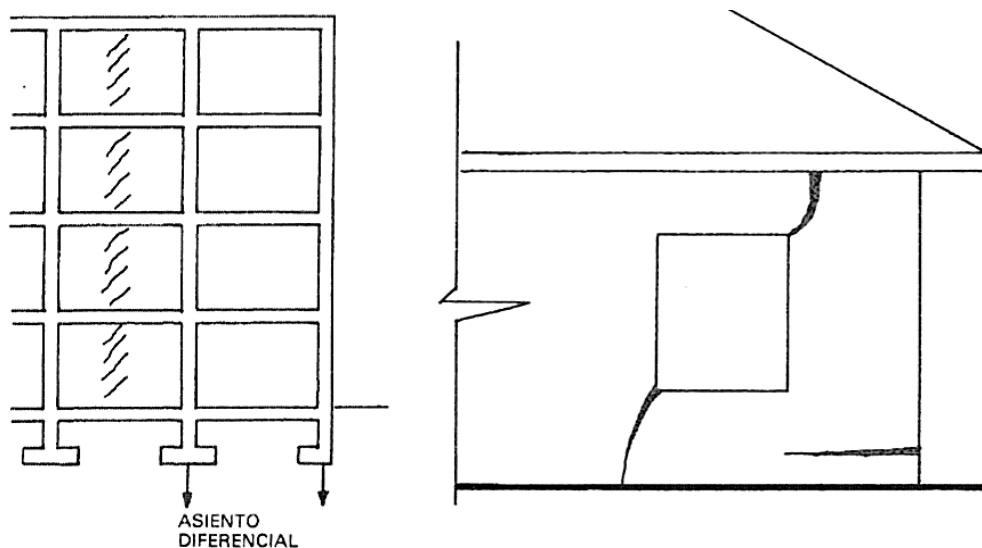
Configuração típica de fissuras causadas por recalques.
